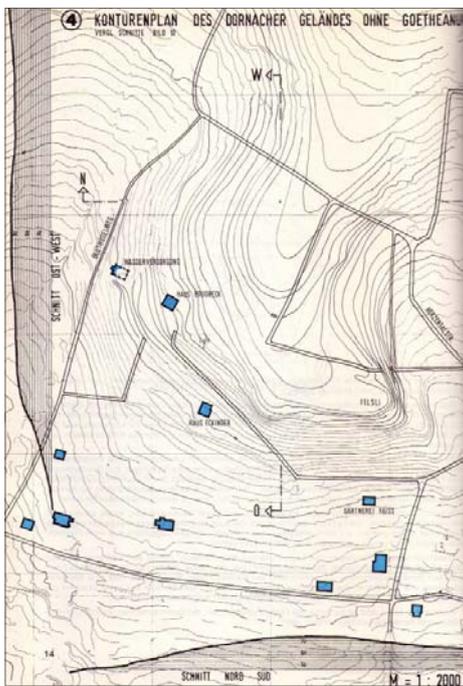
Rudolf Steiner - Planimetria terreno collina di Dornach, Preesistenza. Dornach, Svizzera.
